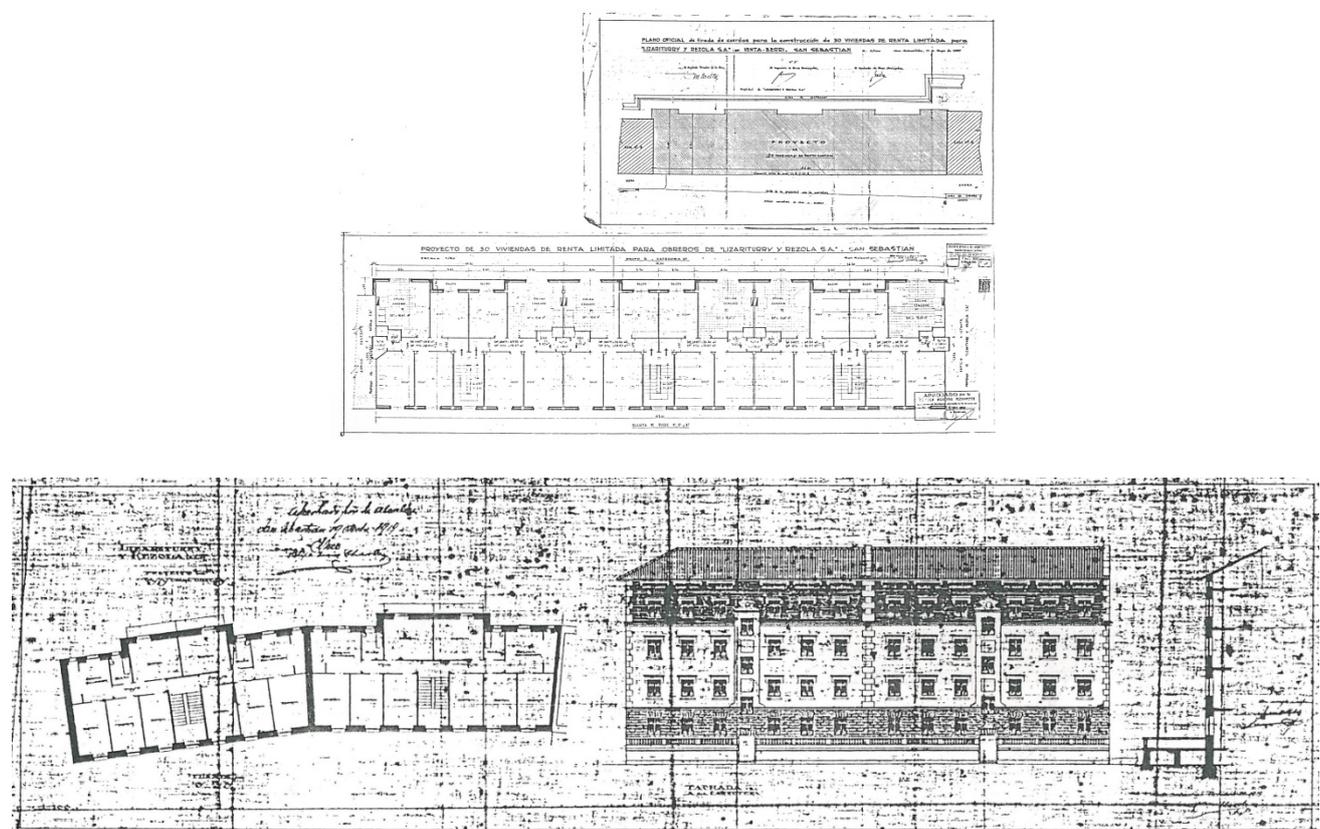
Casas para obreros de Lizarriturri 1919 - F. Urkola - M.E.P.G.. Pág. 37
